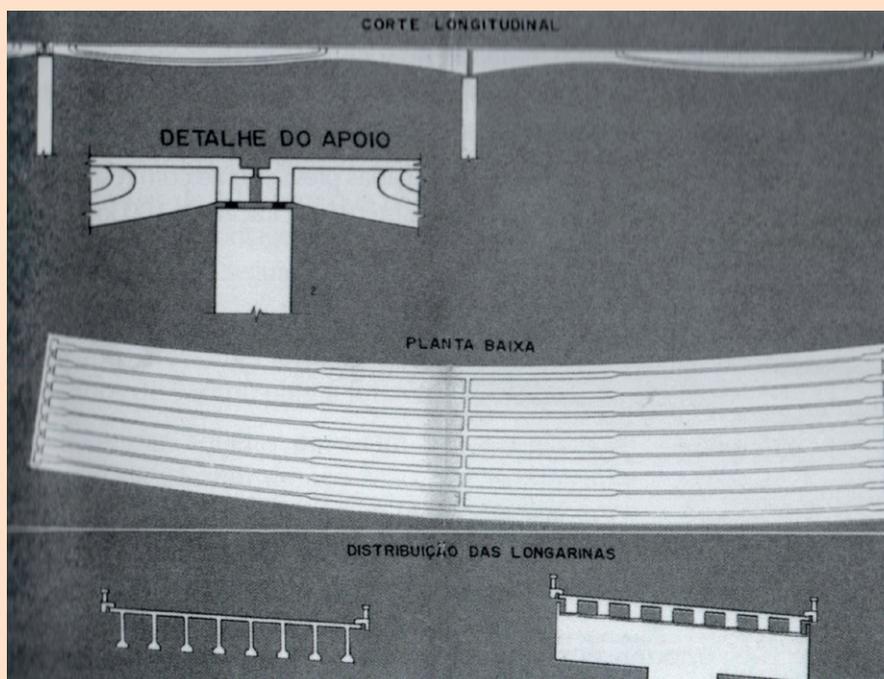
PERFIL LONGITUDINAL E SEÇÃO TRANSVERSAL DO TABULEIRO EM VIA CONTÍNUA [10]
